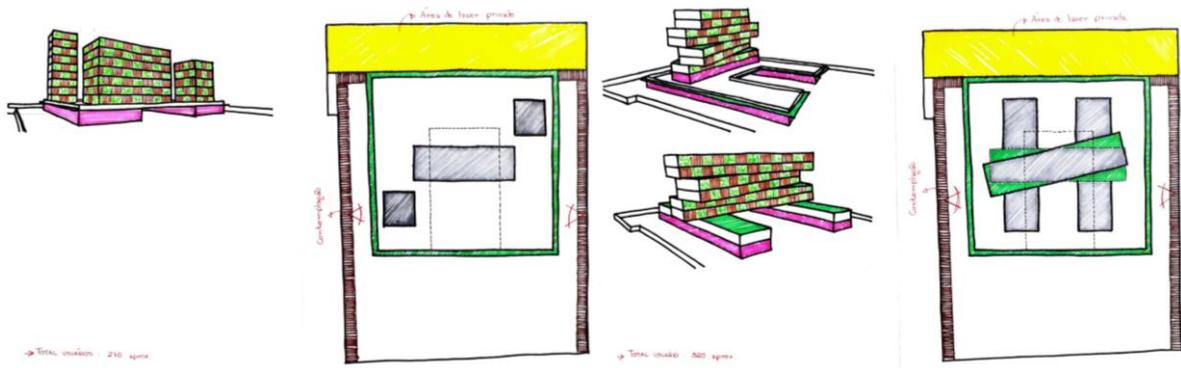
Quadro de croqui do ensaio projetual – 1º ensaio.
